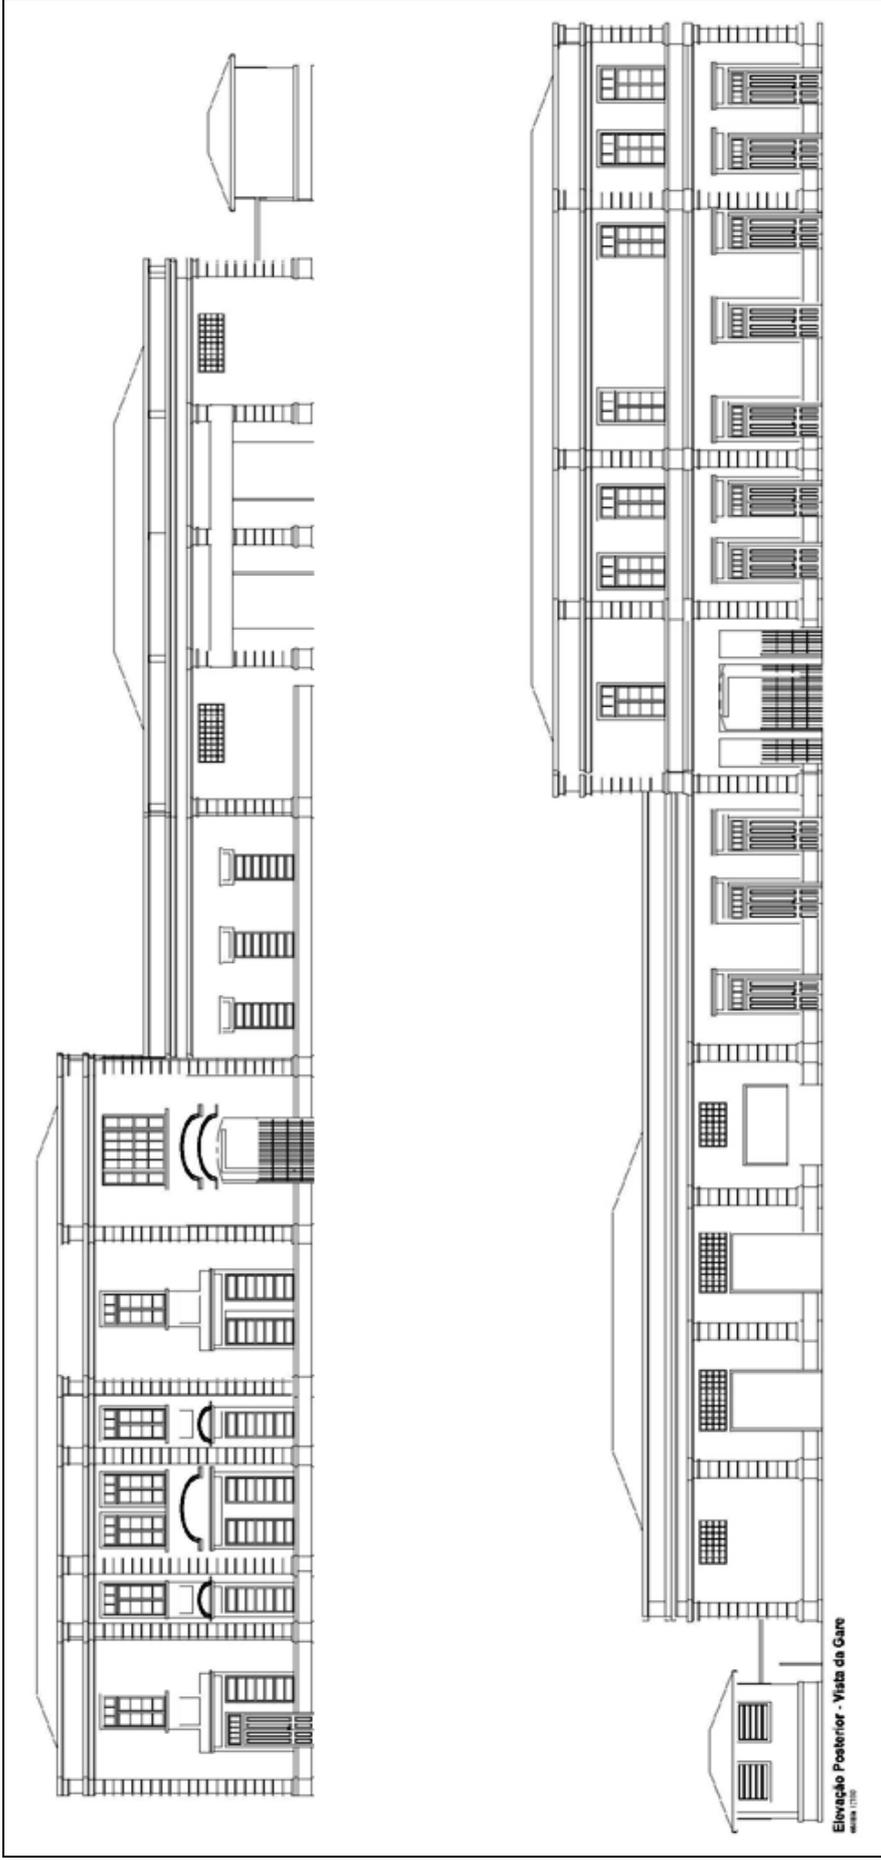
Croqui digitalizado das fachadas de elevação posterior e da vista da gare.
